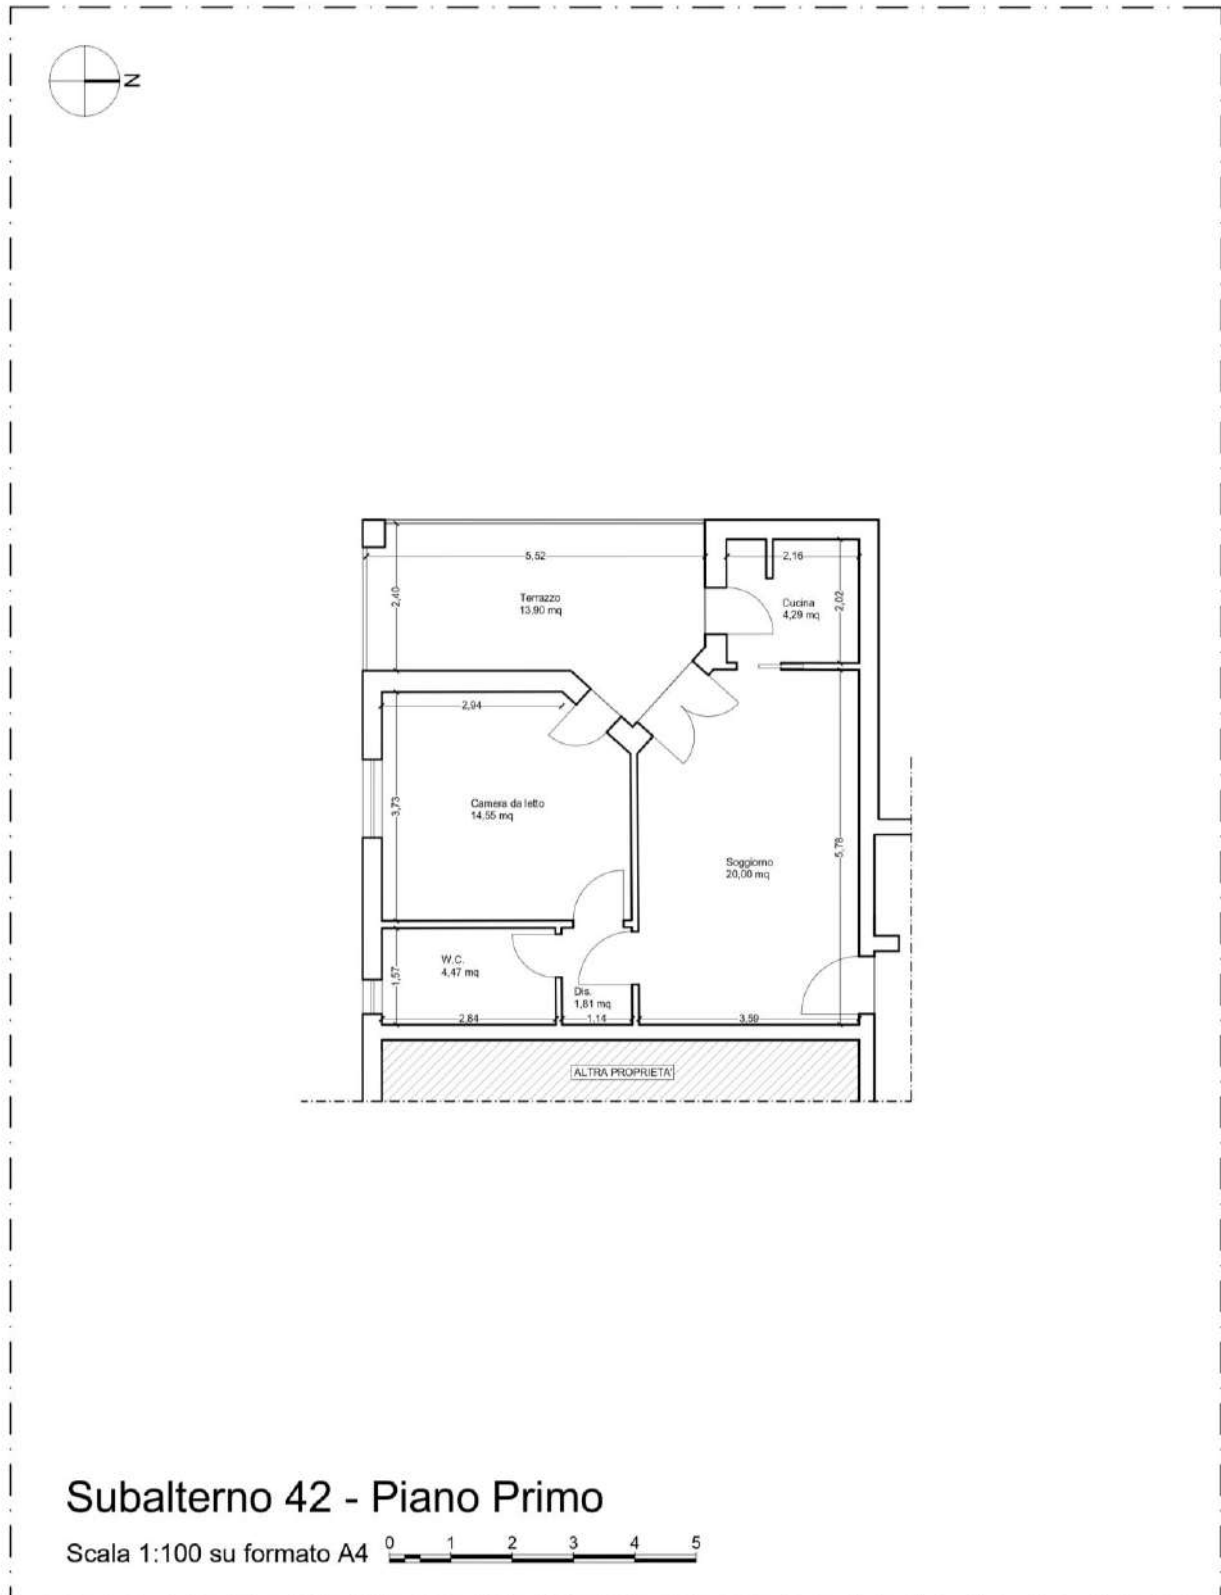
Subalterno 42 – Piano Primo – Planimetria dello stato di fatto rilevato
